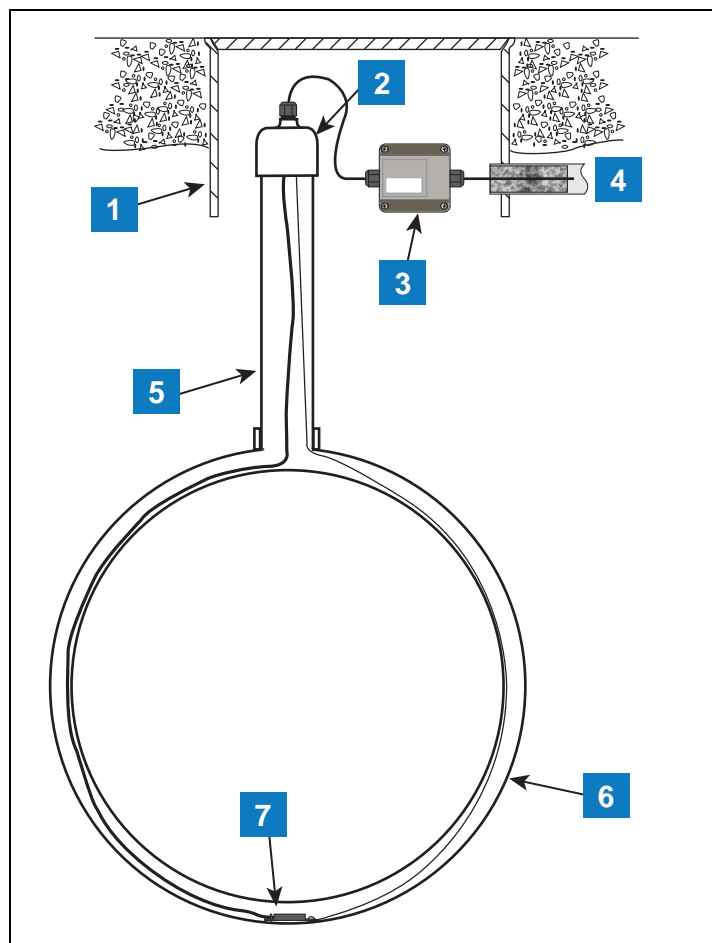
Příklad instalace v jímce s dvouplášťovou trubkou
